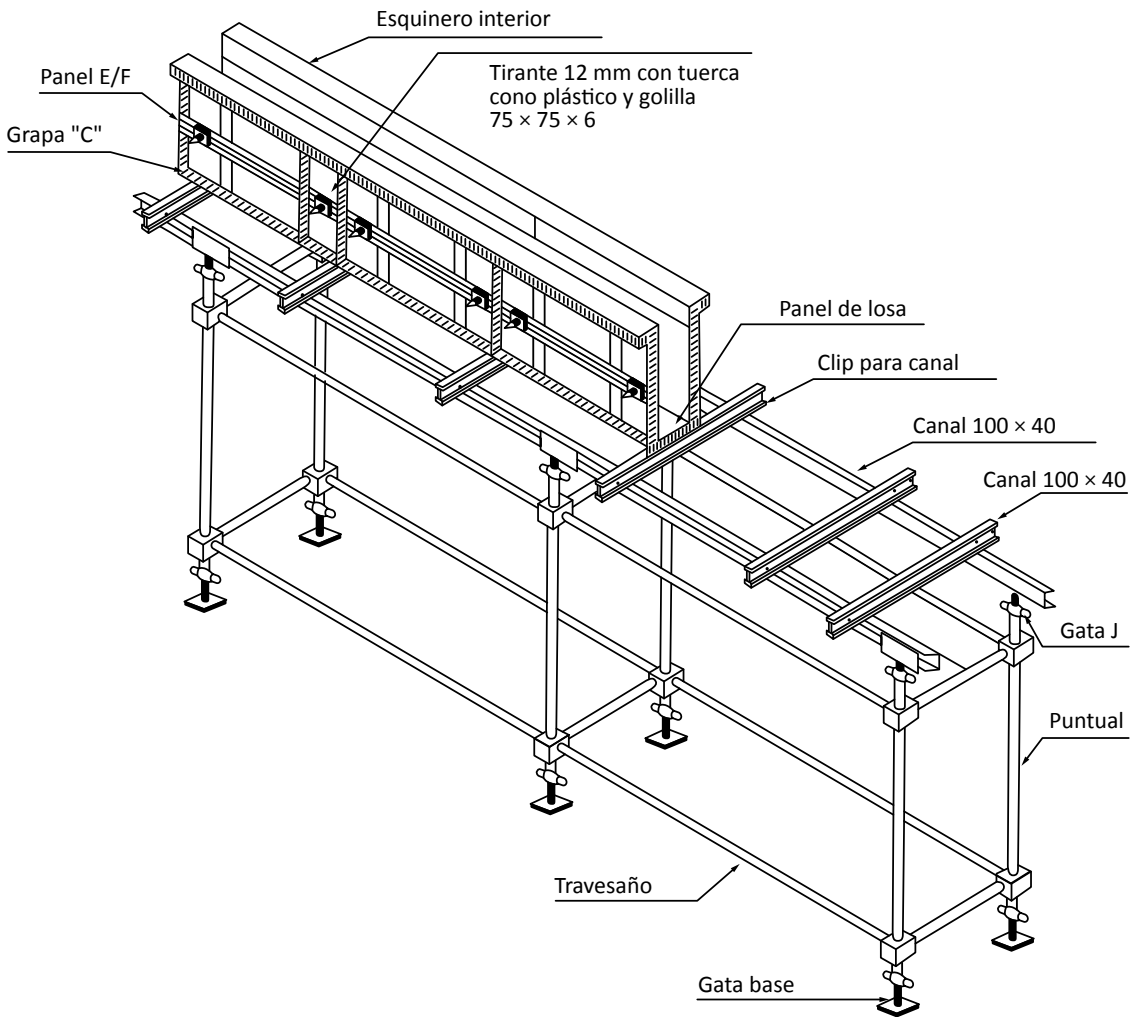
Sistema de losas (superficie metálica o madera)
